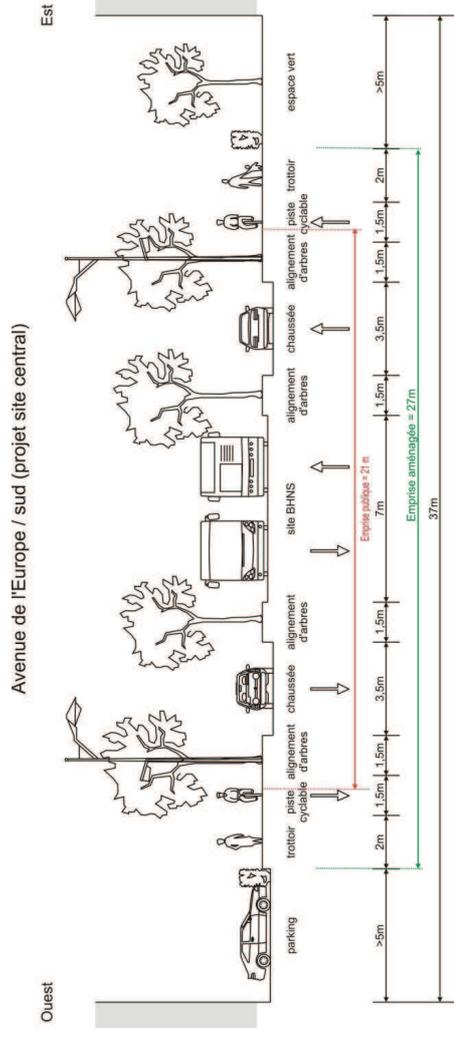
Situation projetée (coupe 28) avenue de l'Europe / section "Sud"
